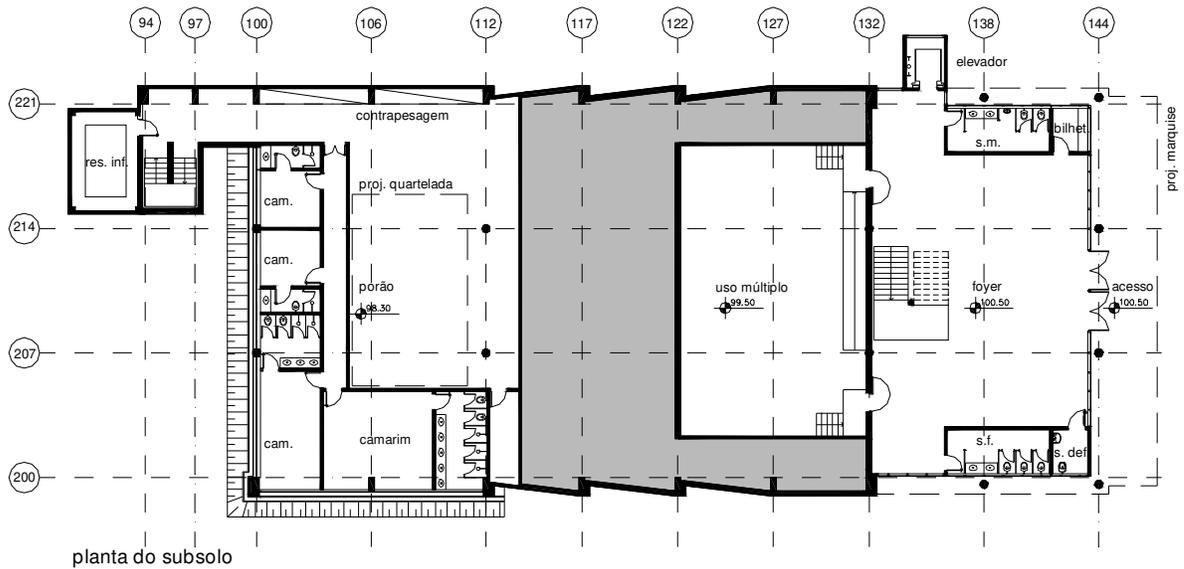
Planta do Subsolo – Teatro Santa Cruz – Sem Escala
